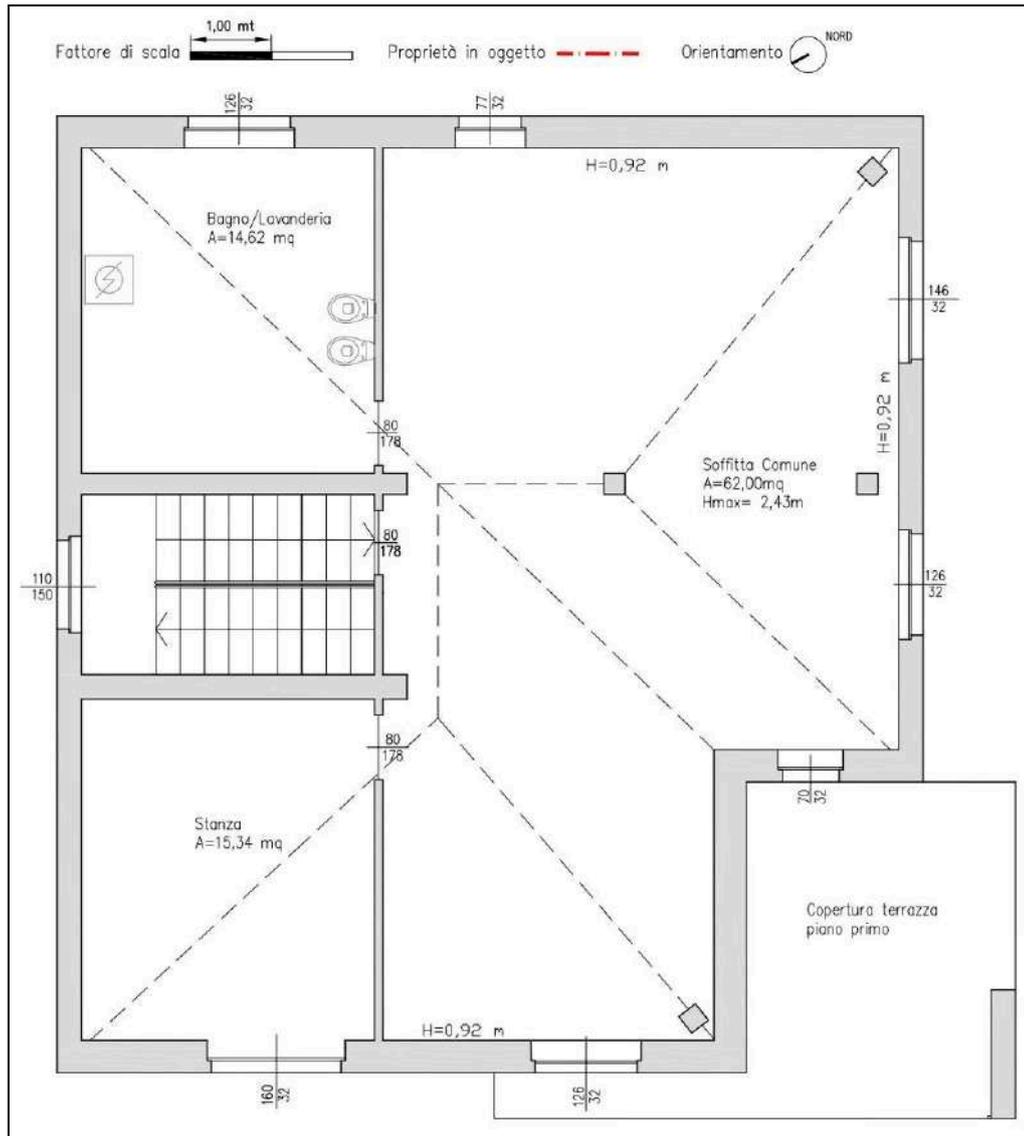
Pianta di rilievo piano sottotetto/soffitta comune
